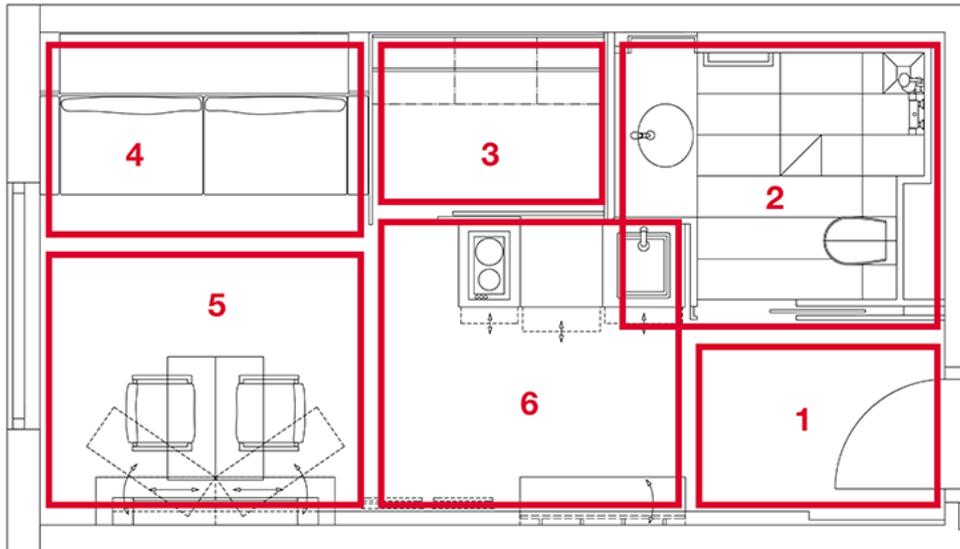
Grundriss ‚MicroApart 20/30‘³⁷⁹
